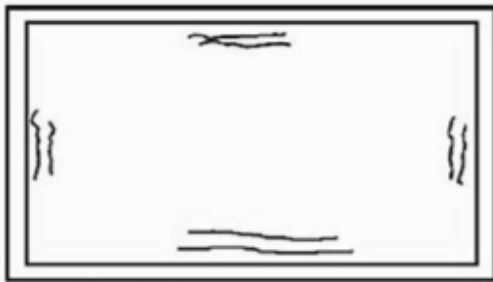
Fissuração por esmagamento do concreto, por reduzida espessura da laje. As fissuras surgem na face inferior, por deficiência diante dos momentos negativos
